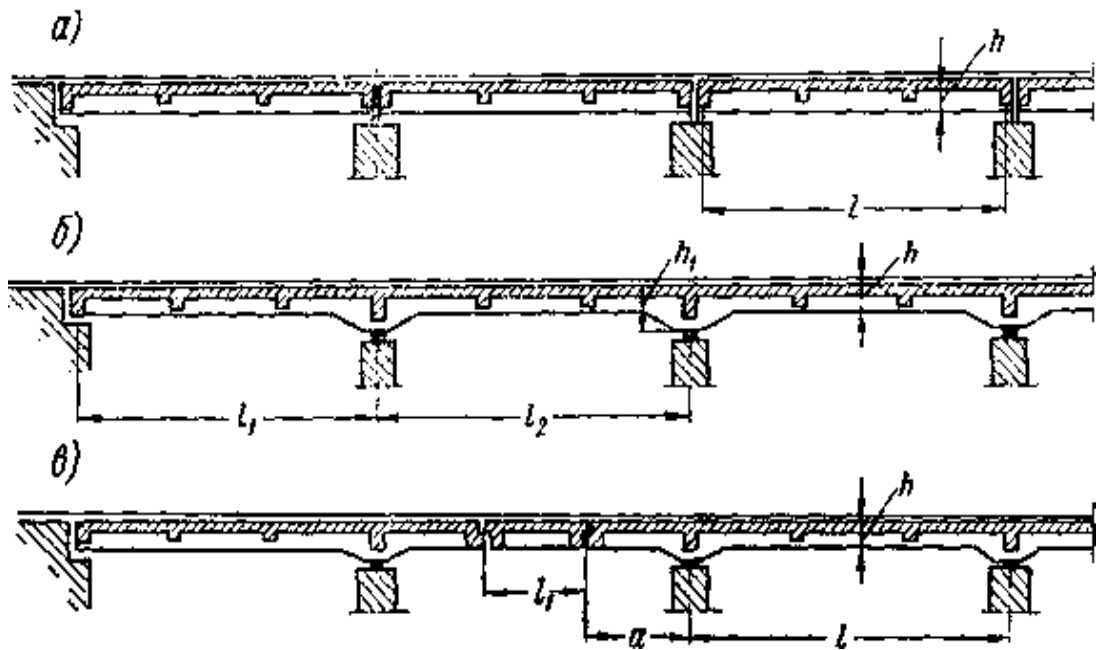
Схеми поперечних перетинів збірних балочних залізобетонних пролітних споруд
